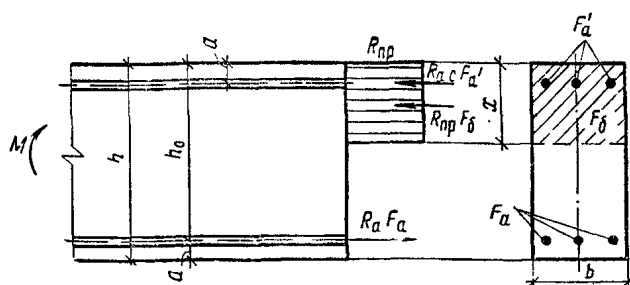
Схема усилий и эпюра напряжений в сечении, нормальном к продольной оси изгибаемого железобетонного элемента, при расчете его по прочности
